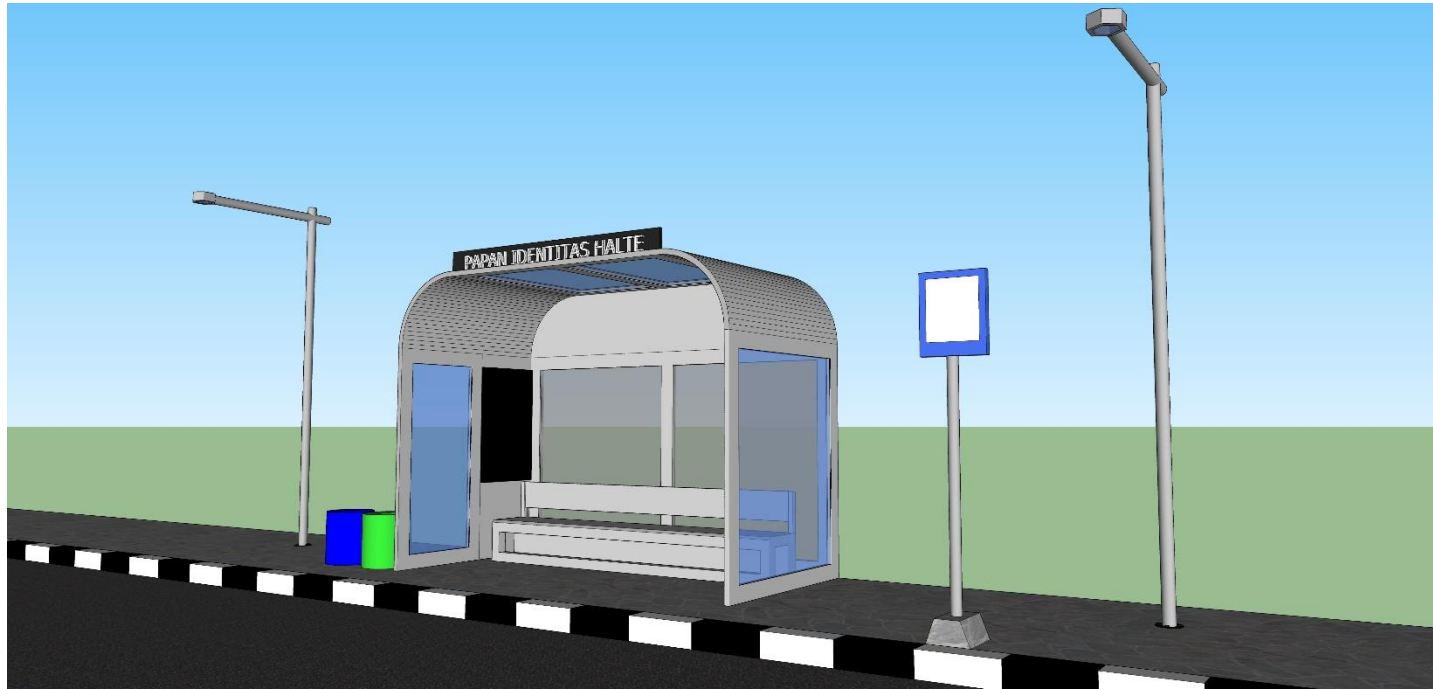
Usulan Desain Tampak Samping Kiri Halte
